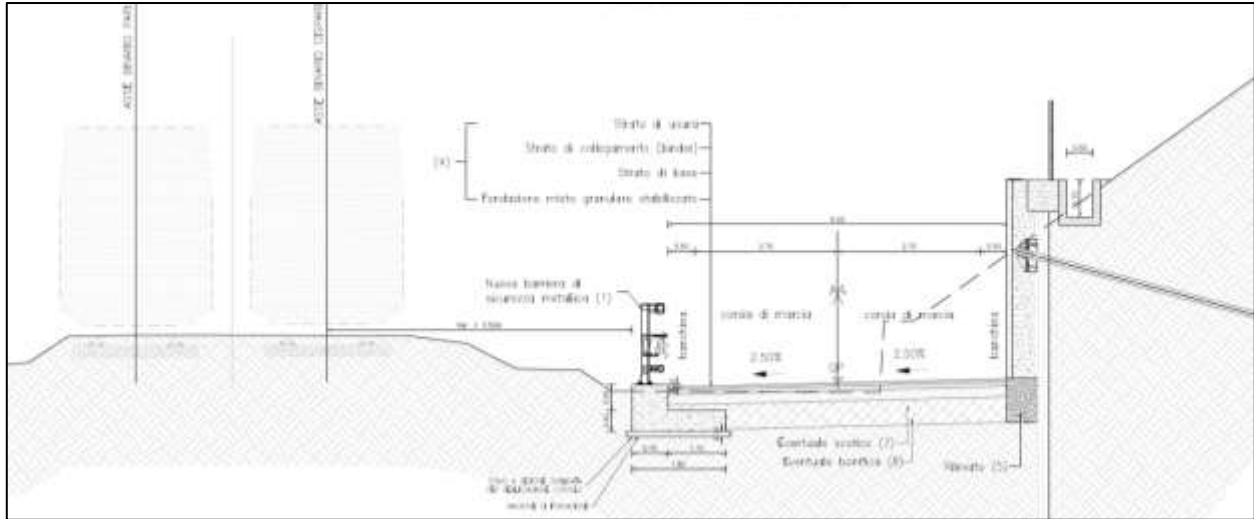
Sezione tipologica stretto affiancamento con riqualificazione della viabilità esistente
